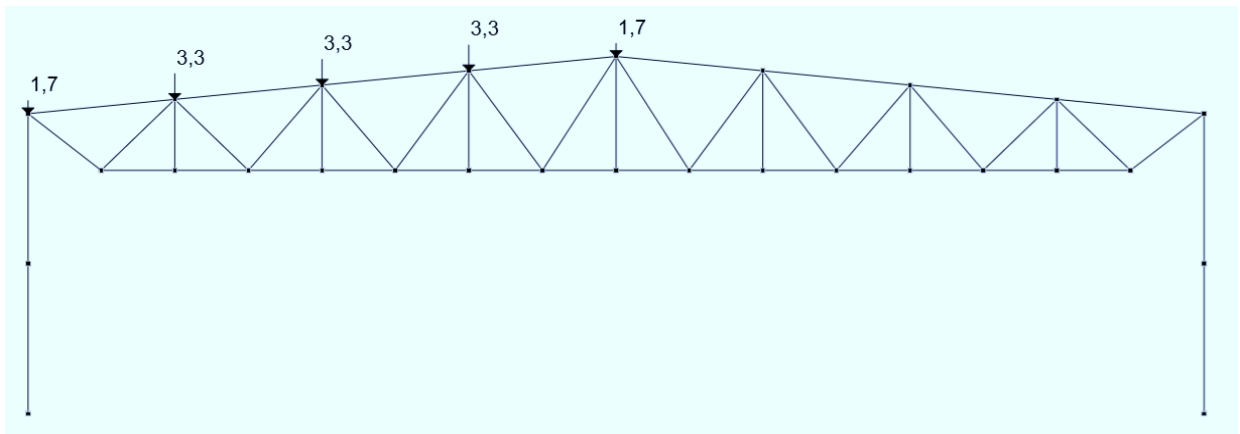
Схема прикладання завантаження № 4 «Снігове навантаження» на ліву частину каркаса будівлі
